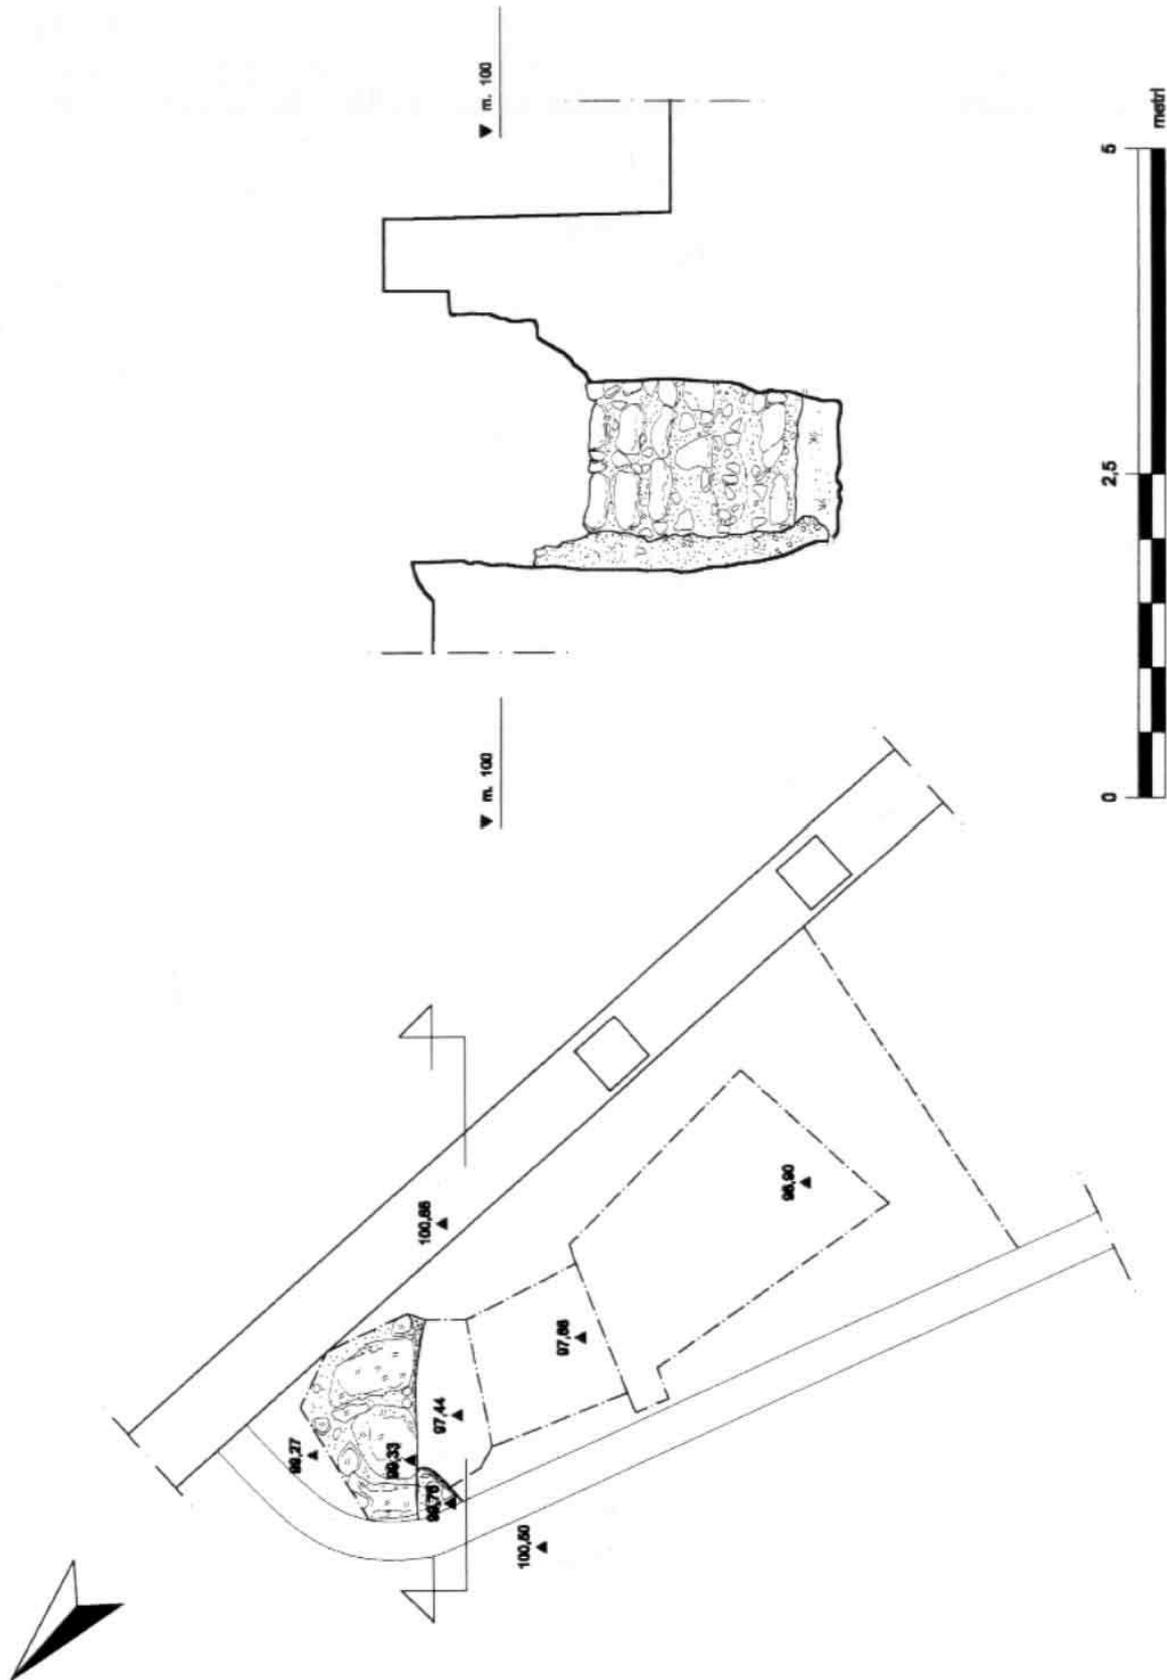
Pianta e prospetto del lato interno della fondazione dell'abside (M. Bianchini).
